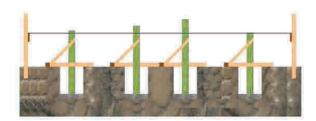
46: Control geométrico de los pilotes, planimetría y altimetría según plano. Arriostramiento de pilotes para cuidar la verticalidad durante el hormigonado del cimiento.
